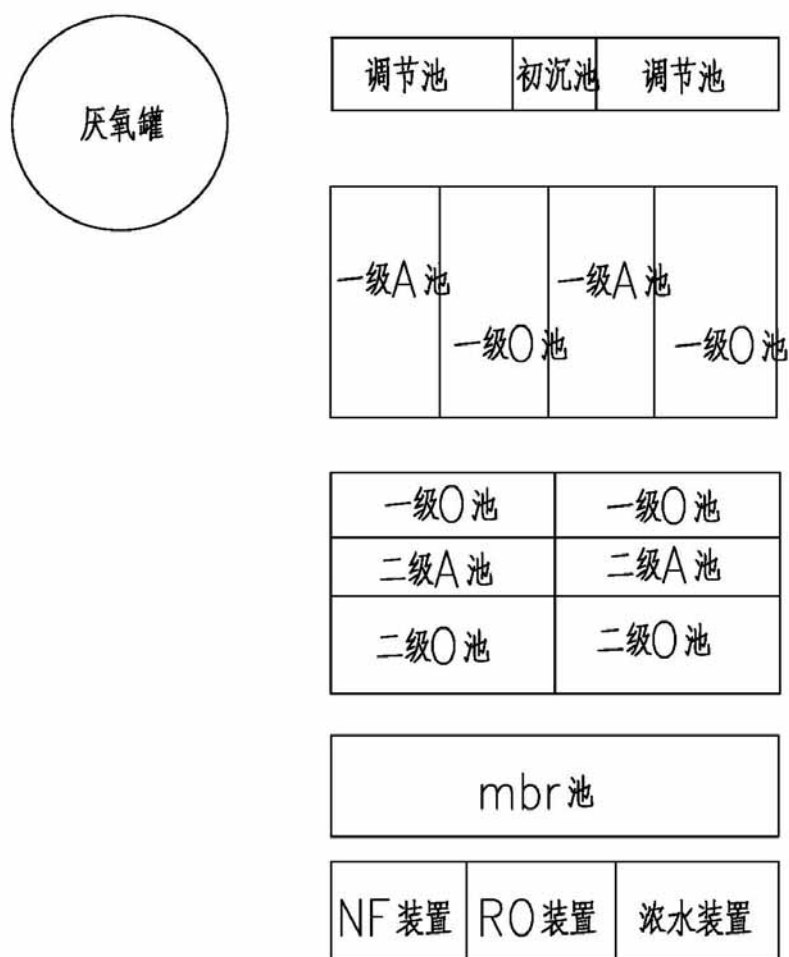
渗滤液污水处理站平面布置示意图
